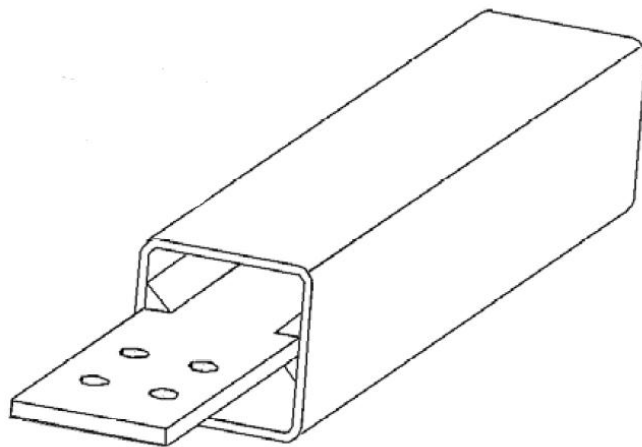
Nus soldant la placa a la cara del RHS.
